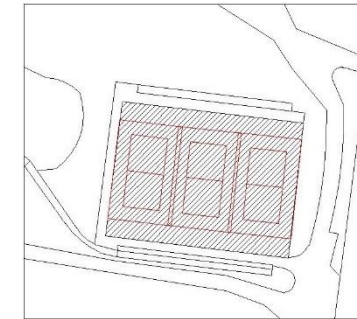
Pista de entrenamiento (3 pistas solapadas de 14x22 m)
